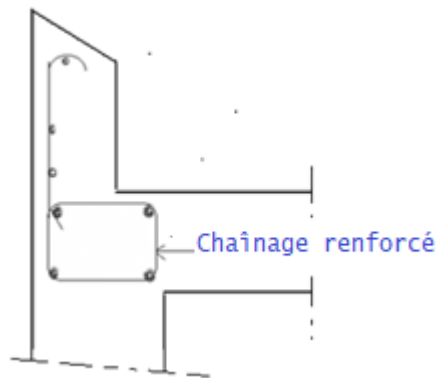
Exemple de ferrailage d'un acrotère haut [1].
